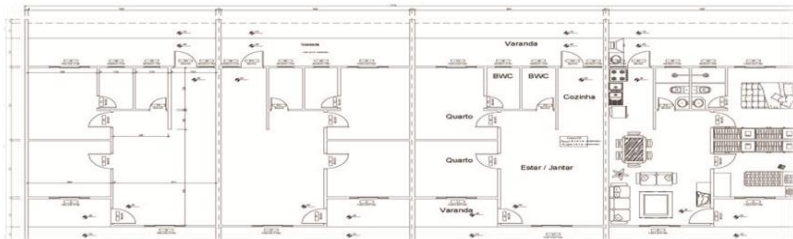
Configuração da planta baixa das residências padronizadas em nível. Fonte: Construpex (2009)
